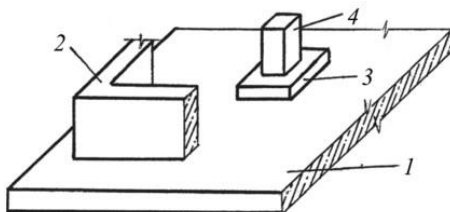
Розміщення стін і колон на плитному фундаменті
